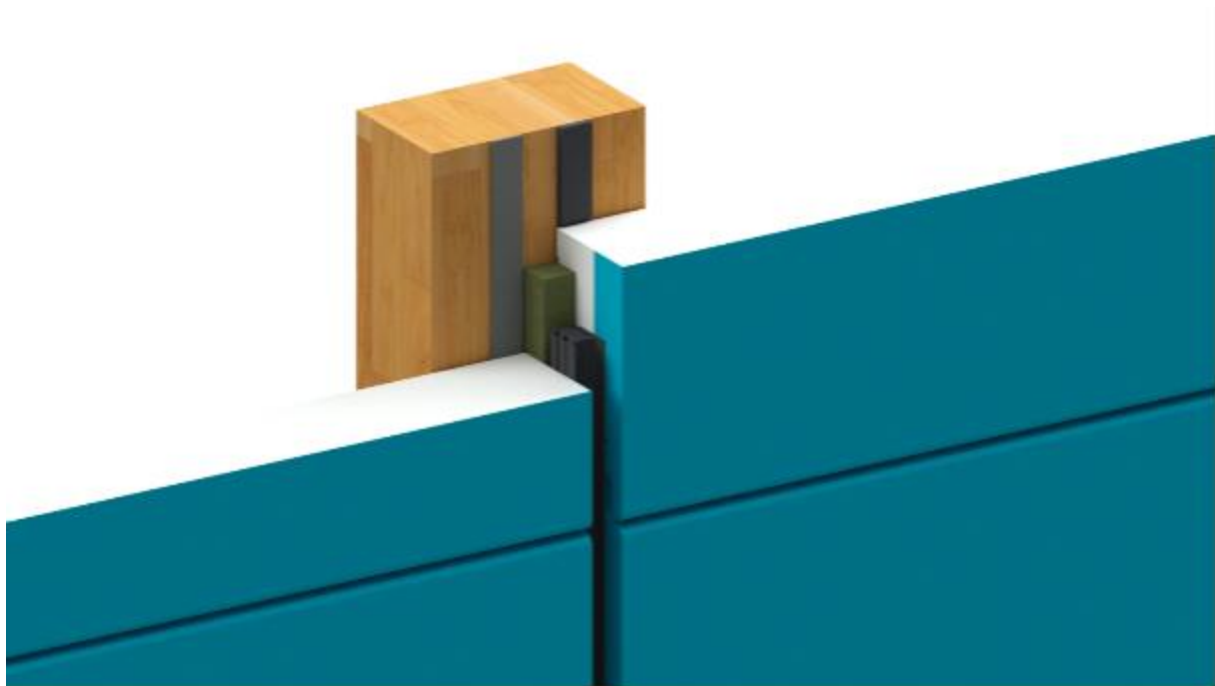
Exemple d'une jonction verticale en pose horizontale avec panneaux sandwich isolants Louvre et couvre-joint option A (Affleurant) sur ossature acier
